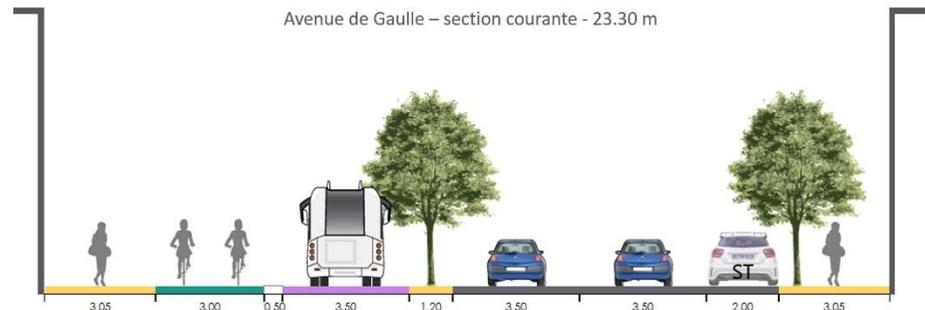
Coupe 1C-1 projet - avenue du Général De Gaulle
